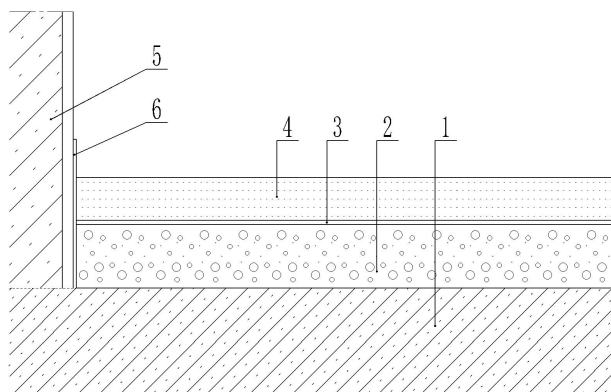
轻质混凝土保温垫层地面保温找平系统构造
